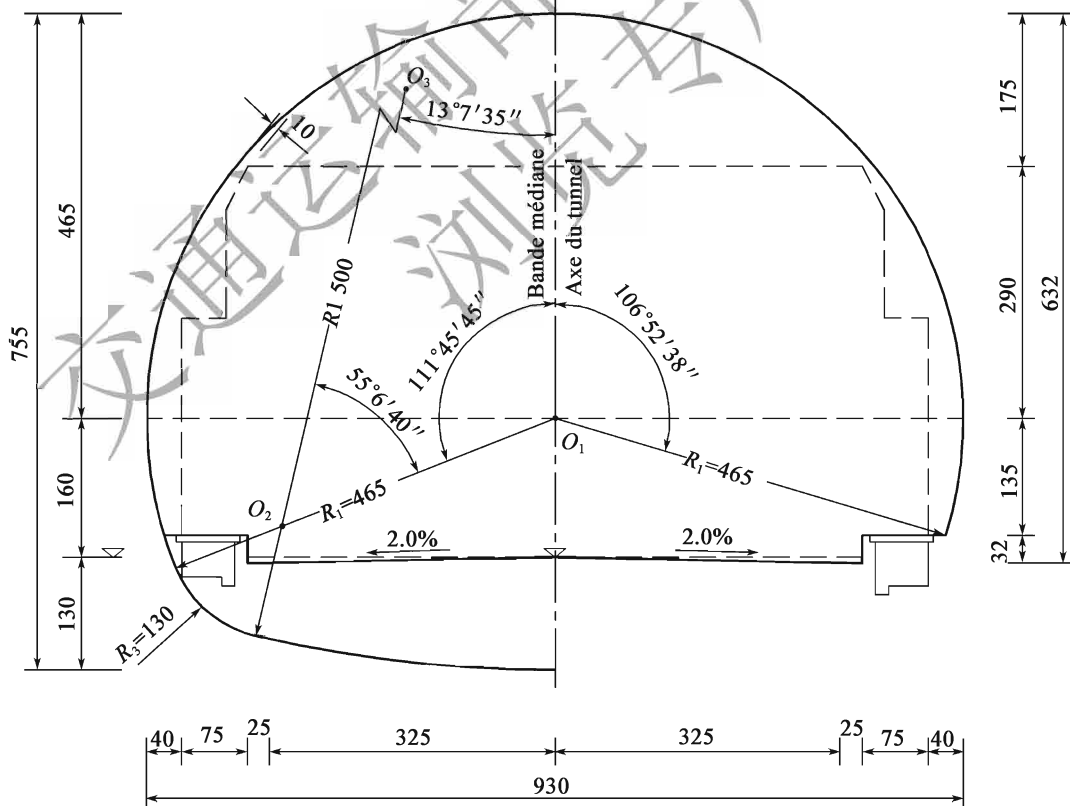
Gabarit du tunnel routier de troisième classe à deux voies (30km/h) (unité :cm)
